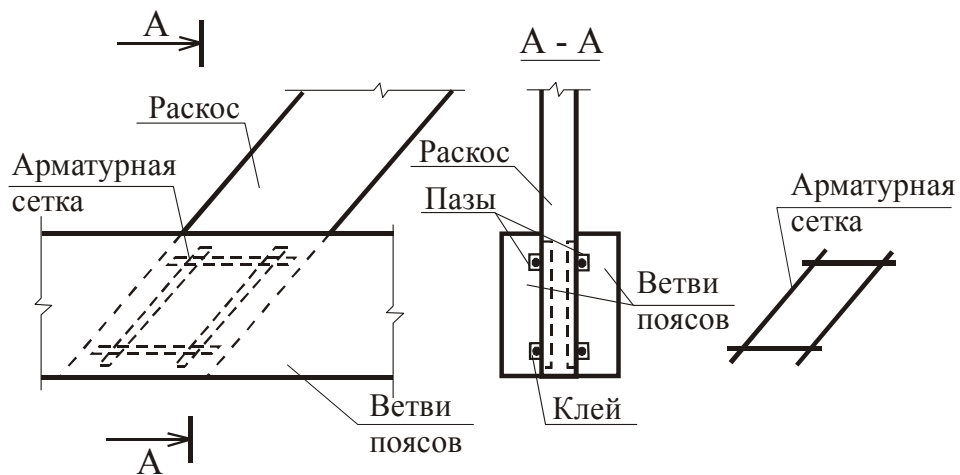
Виды клеевых соединений с арматурными сетками в узлах дощатых несущих ферм
